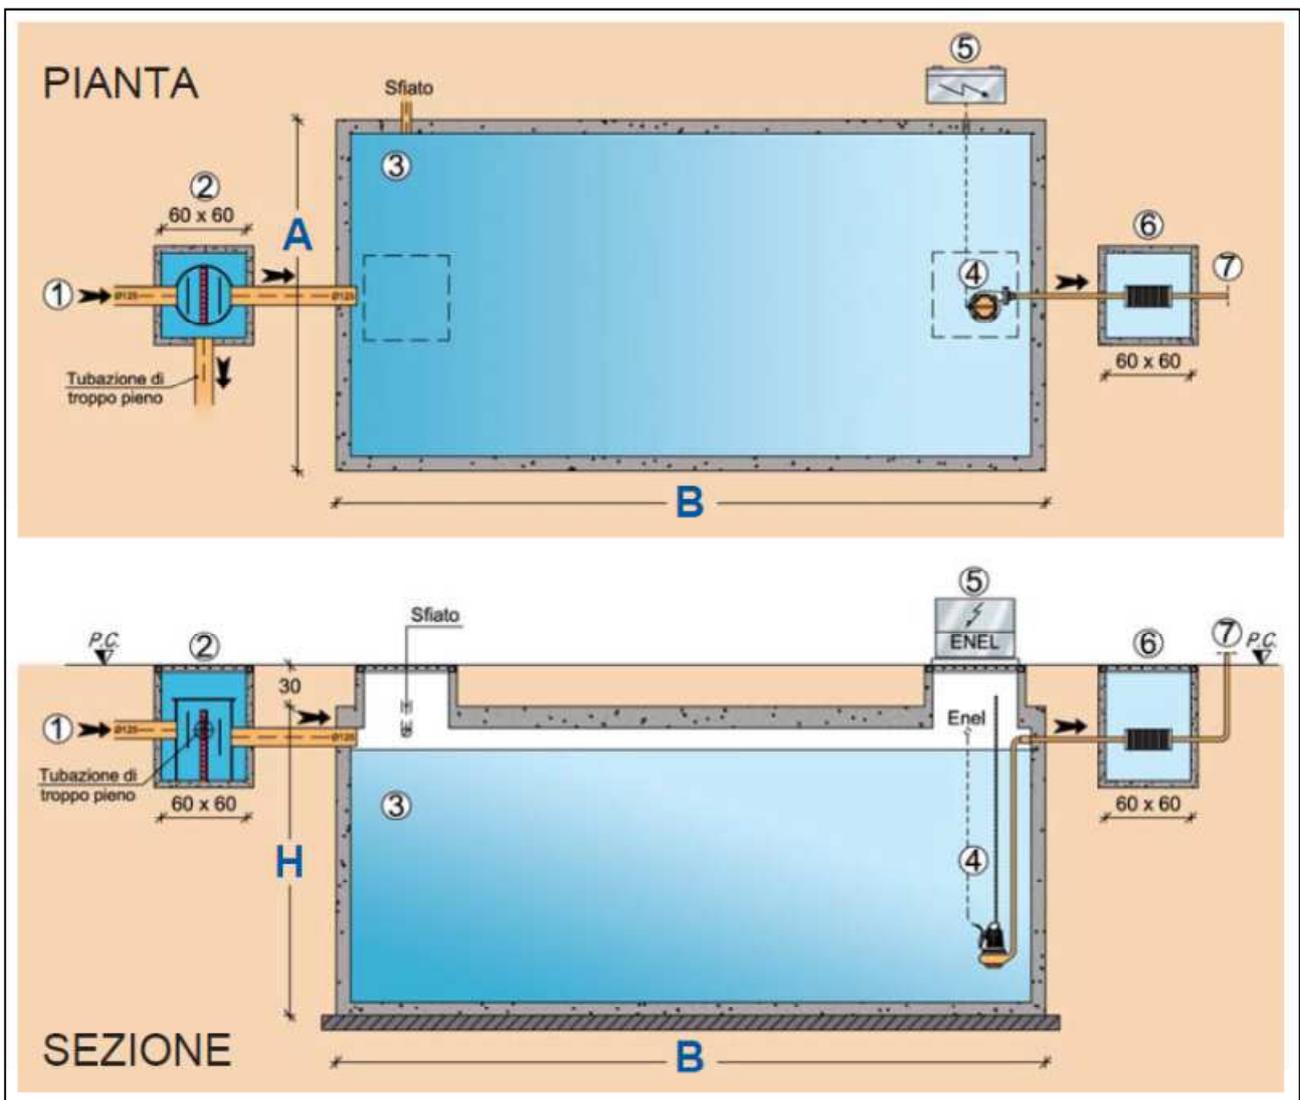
Vista planimetrica e in sezione della vasca di accumulo dell'acqua piovana.
